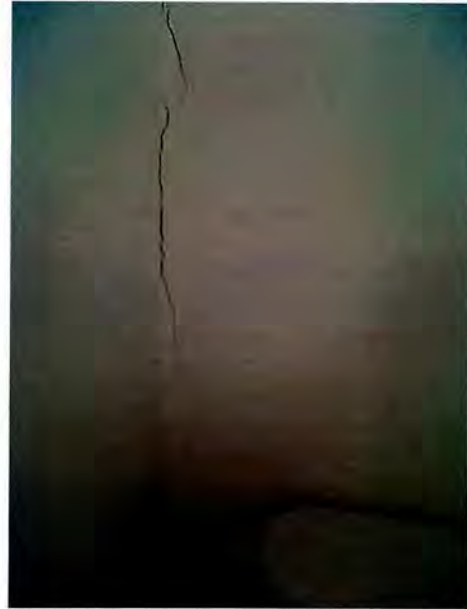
Detalle de fisuras en paramentos verticales.
